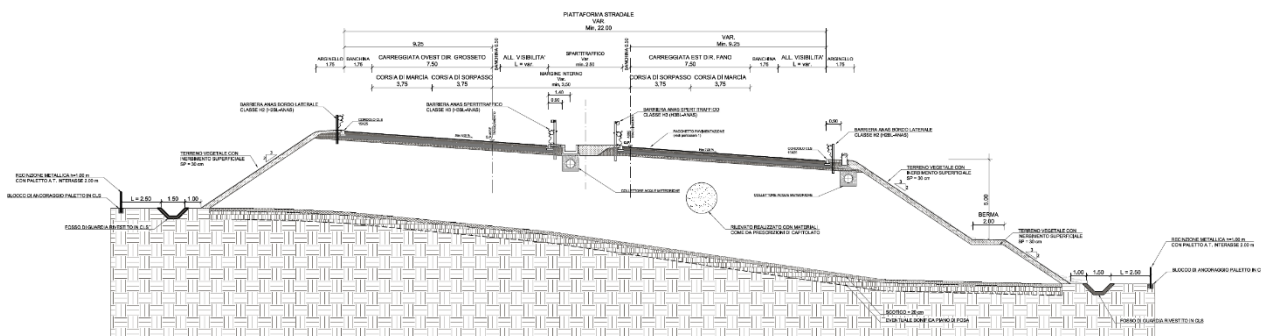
Sezione tipo in rilevato in curva con allargamento
